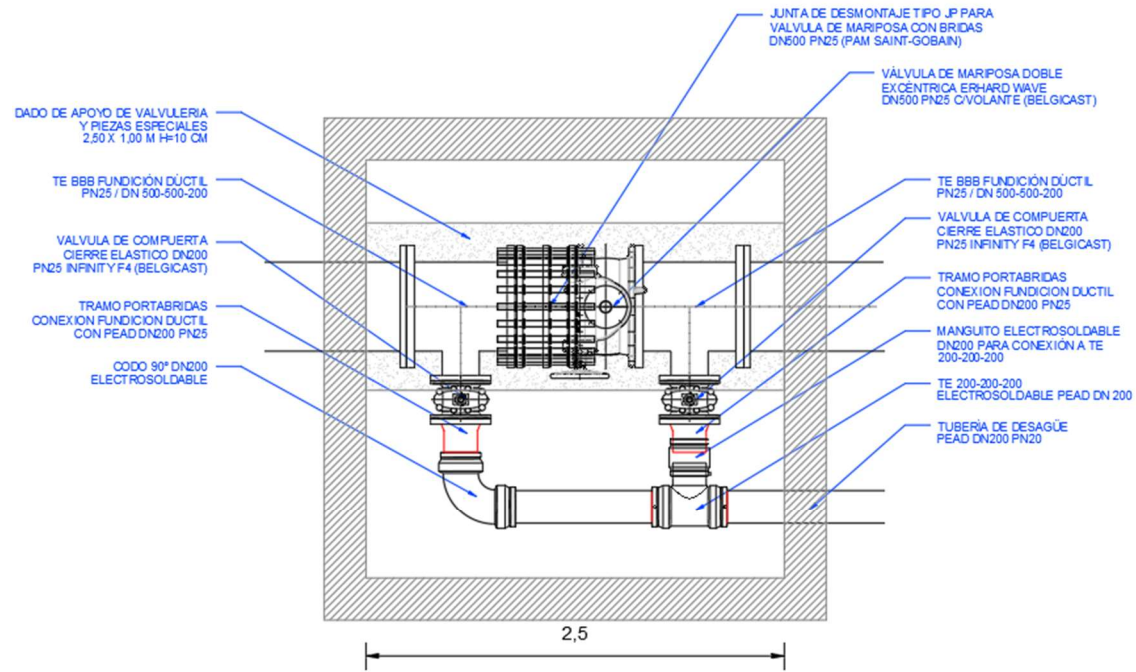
Planta General de la Arqueta de Desagüe. Fuente: Elaboración propia
